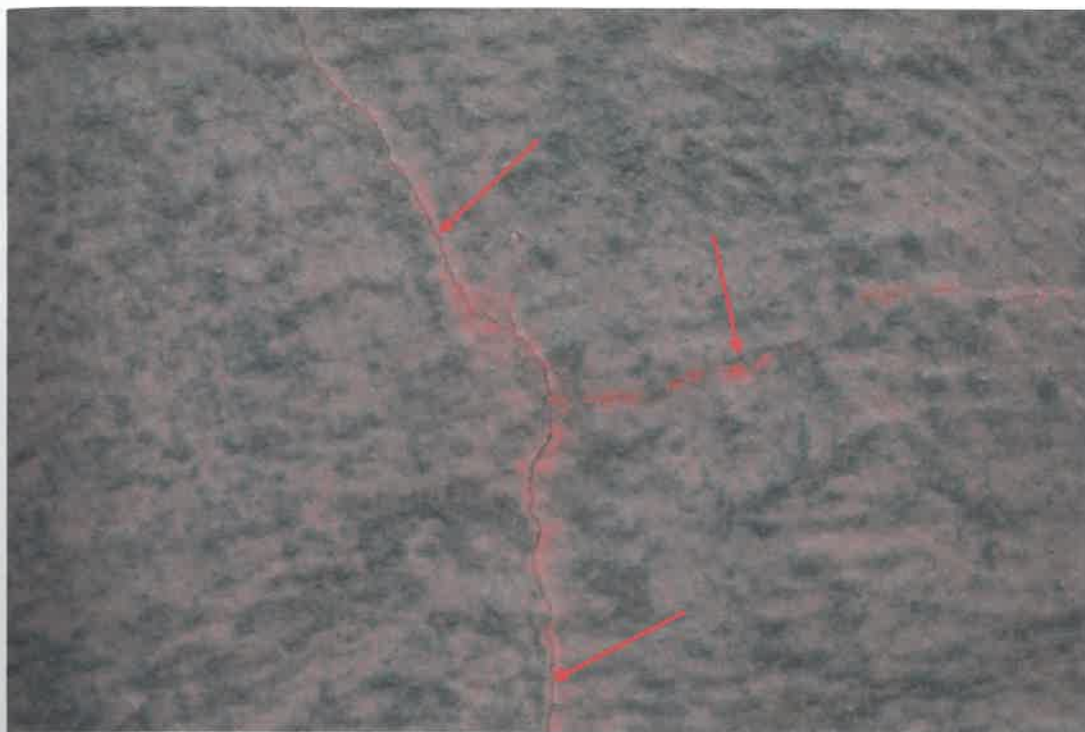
Galeria na poziomie +41,40 m - widok od strony wschodniej. Zacieki na powierzchni żelbetowego trzonu komina
